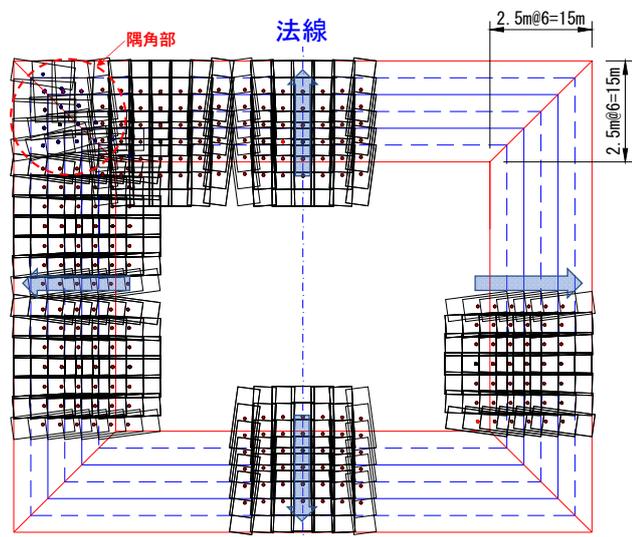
法面部掘進 (法面直角方向) イメージ平面図
